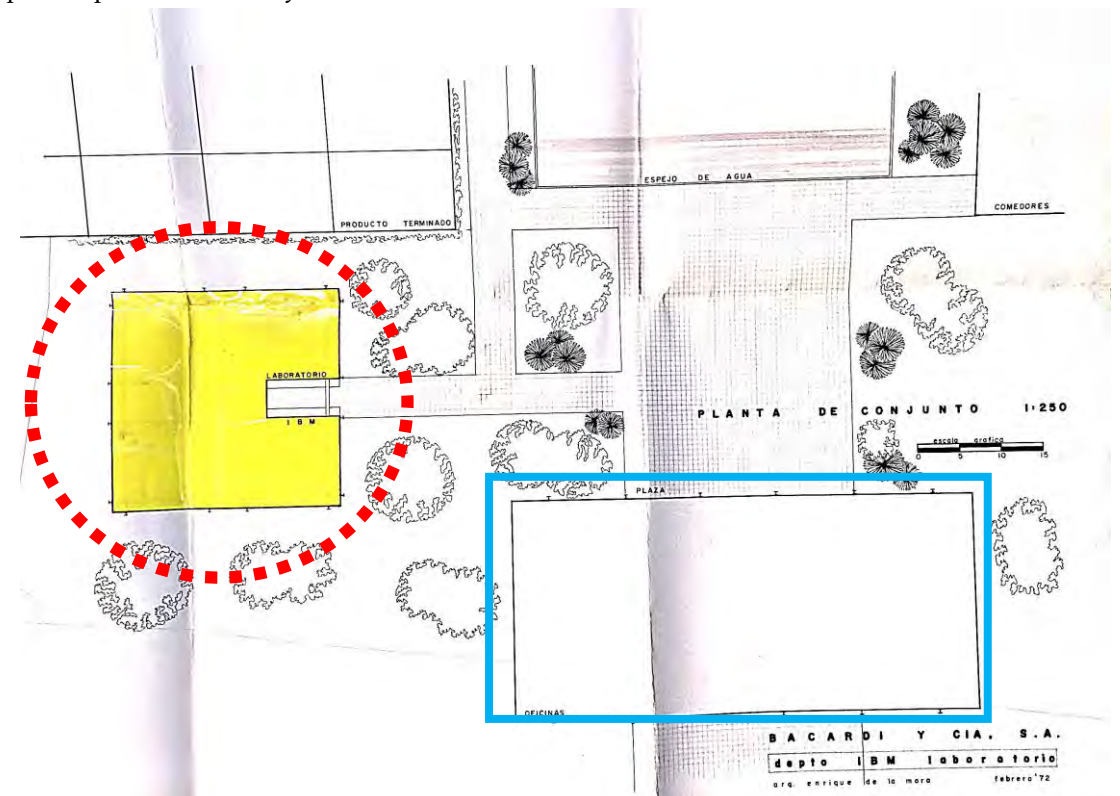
Planta de Conjunto Proyecto Laboratorios IBM Bacardí
